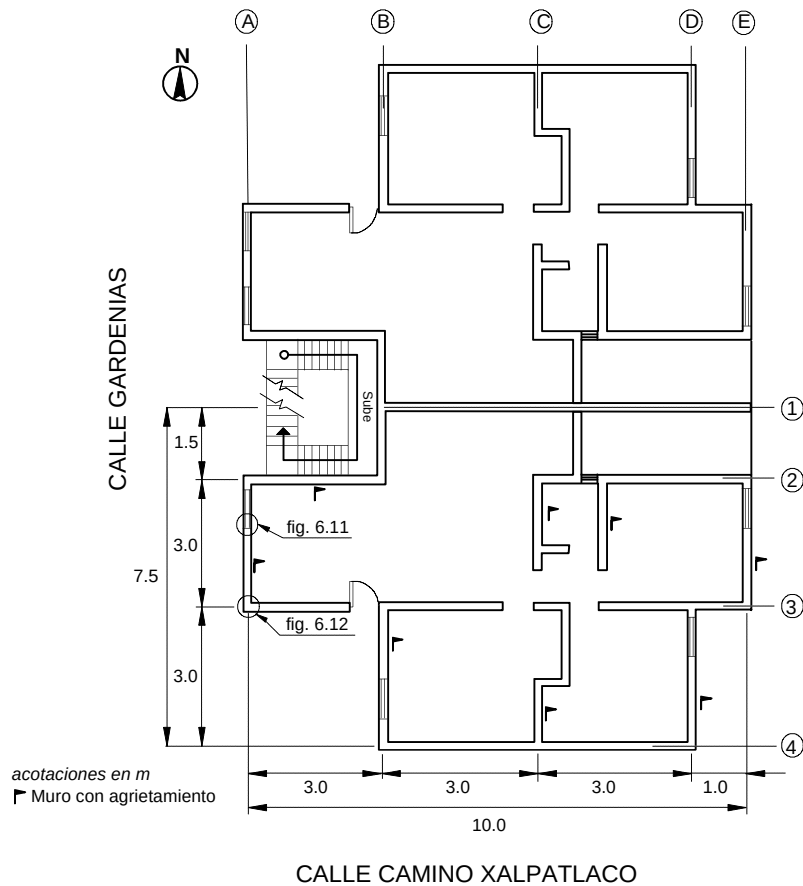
Distribución del daño en la planta baja del edificio 002
